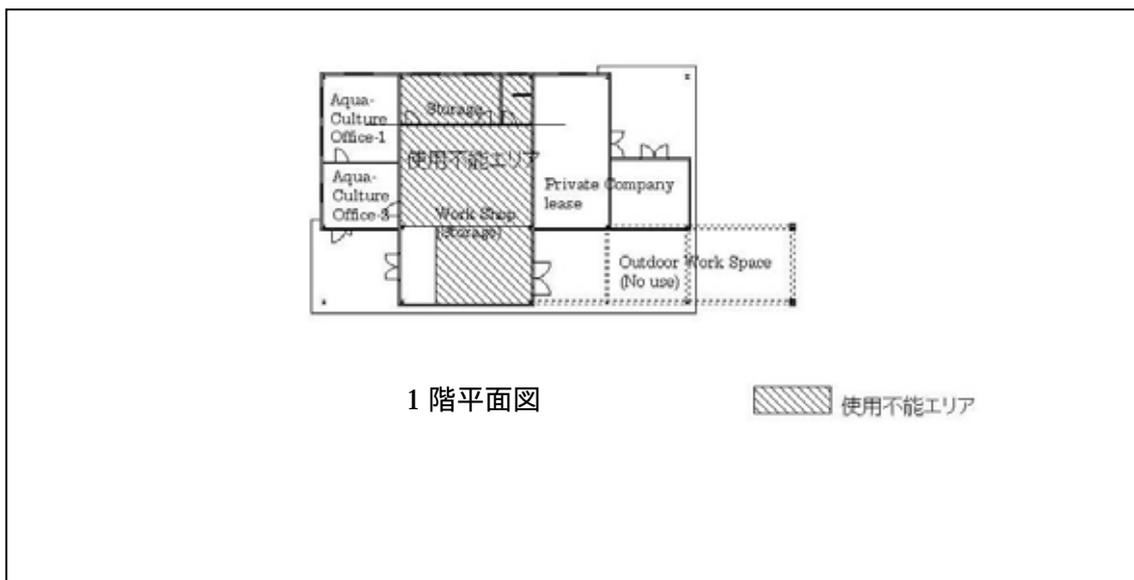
(3) 水産センターワークショップ棟の現況平面図
